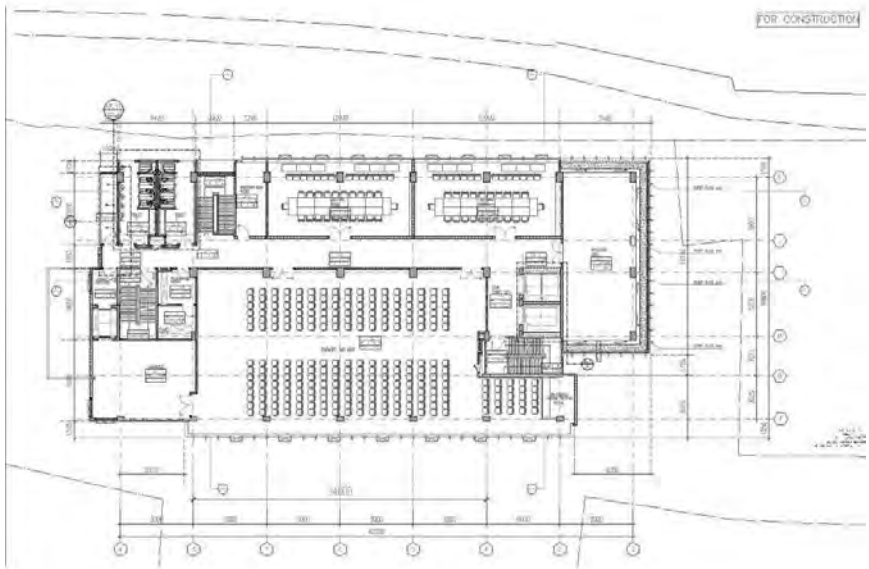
menunjukkan pada bangunan gedung odua weston hotel jambi pada lantai 2 terdapat 3 buah kolom di dalam ruangan pertemuan pada as H5, H6, dan, H7. Kolom inilah yang akan dihilangkan sehingga dapat memaksimalkan fungsi ruang pada gedung tersebut.
